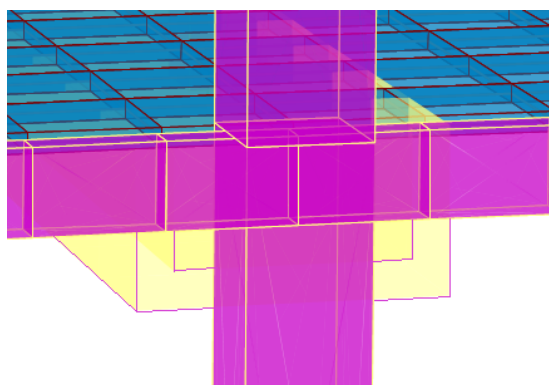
Pormenor da ligação entre os elementos estruturais no *SAP2000*.
